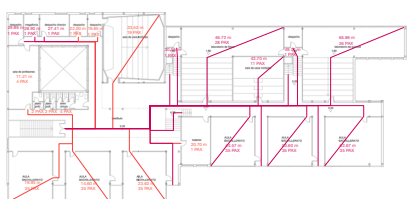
Recorridos evacuación actuales. Planta primera pabellón D.
